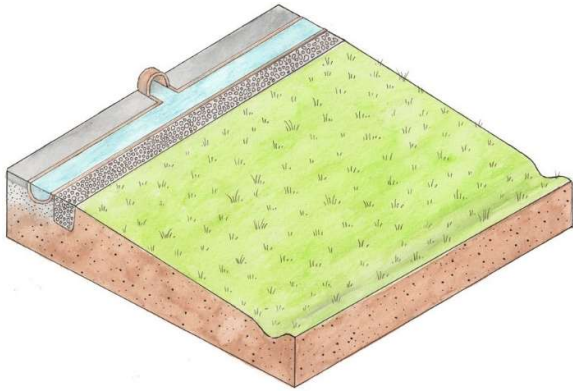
Alternativ lösning för att förbättra planerad dagvattenhantering.
